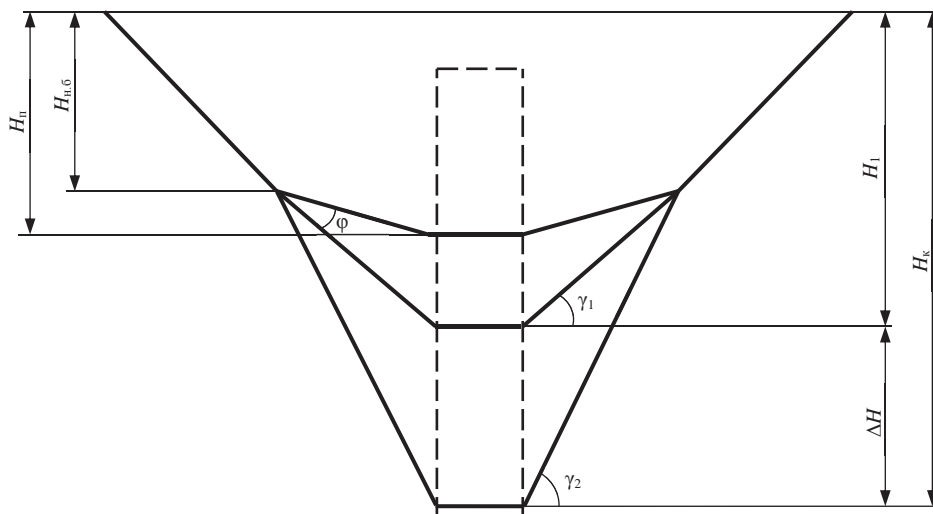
Схема к расчету глубины перехода на вскрытие крутонаклонными съездами:
